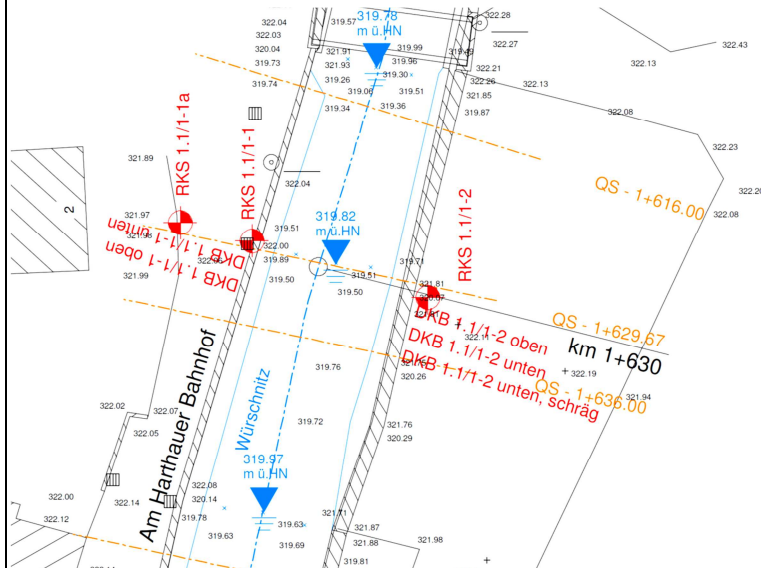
4.5.2: Lageplan Bereich Fluss-km 1+630
